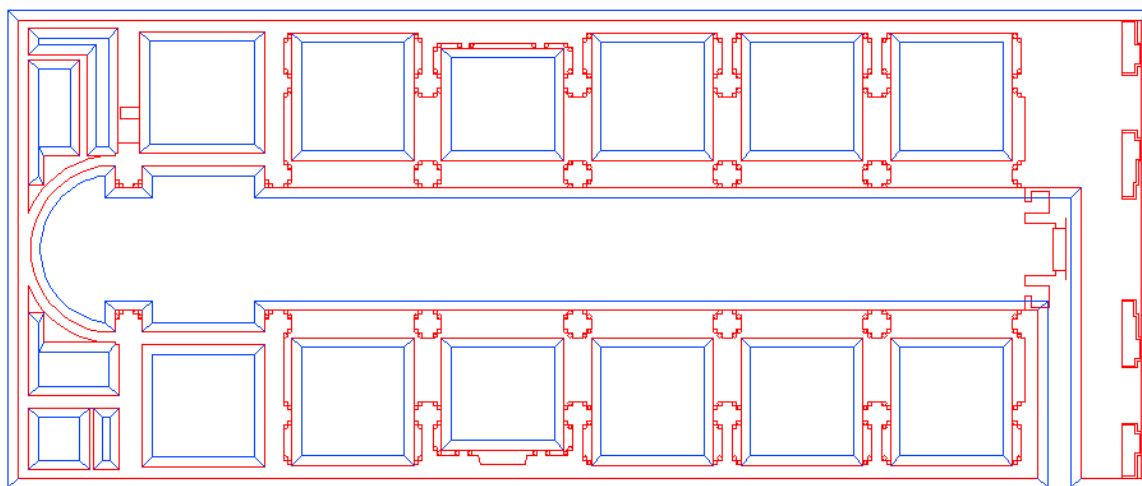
Estructuras que se levantan sobre la cimentación.
